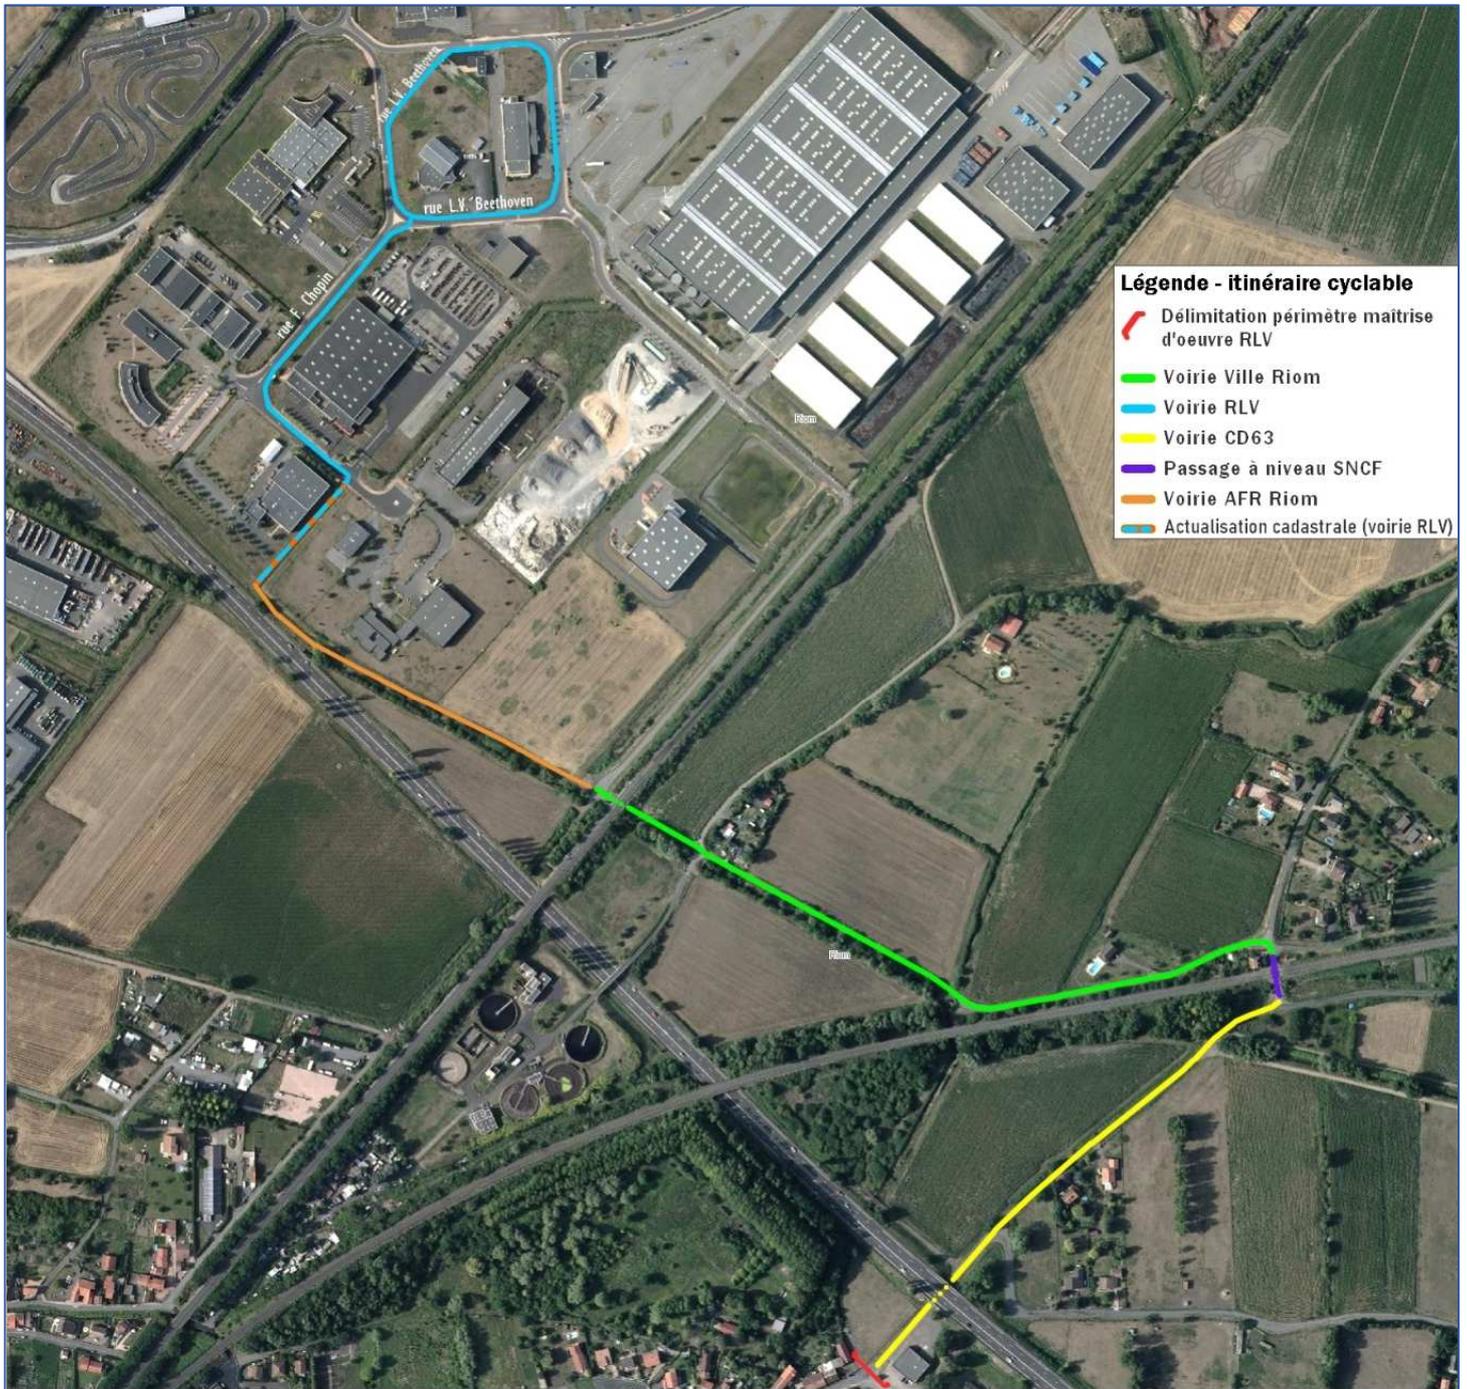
Plan général du tracé (fond plan Intr@Geo - SD services mobilités et transports RLV)
